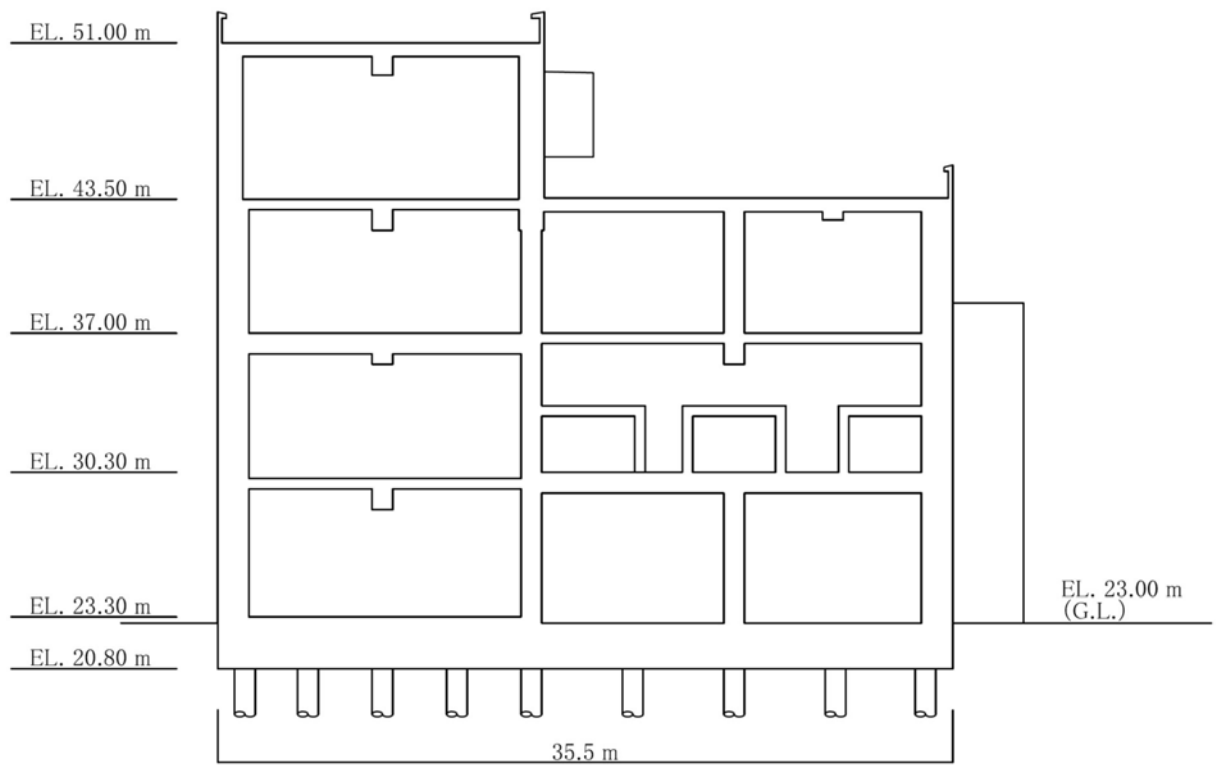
(2/2) 緊急時対策所建屋の概略断面図 (B-B 断面)
